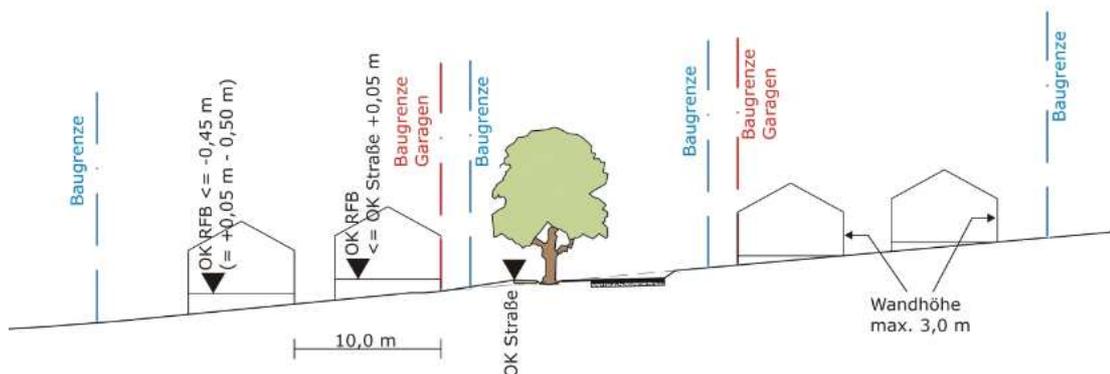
Wandhöhen und Höhenlage der Garagen: Schnitt durch WA 2 Ringstraße
